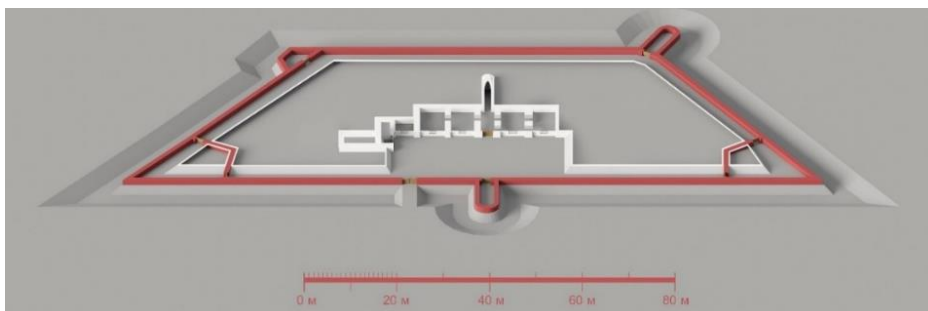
Поздовжній переріз моделі: фундамент форту
